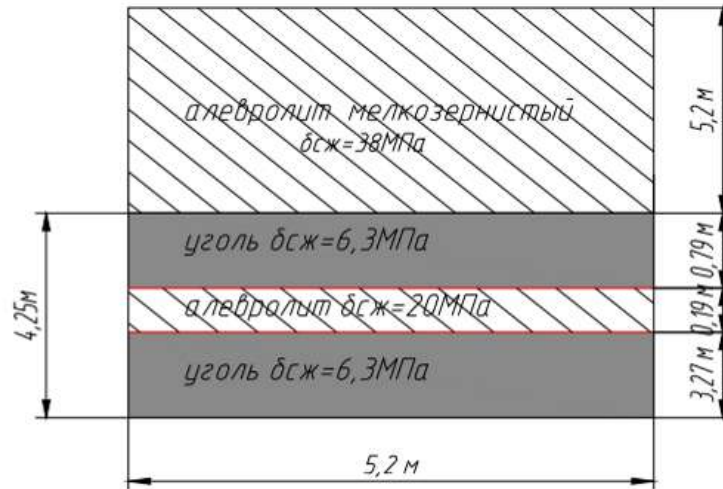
Схема определения сопротивления на сжатие пород кровли и боков выработки
